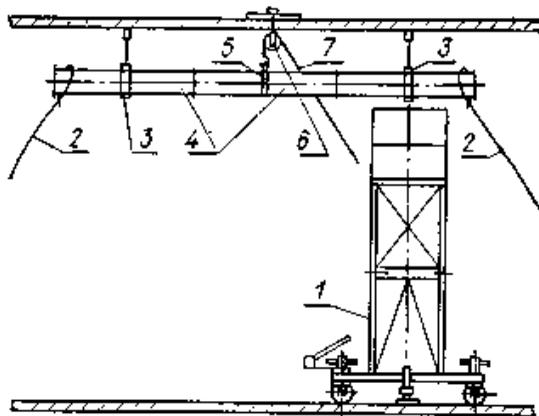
Установка в проектное положение укрупненного блока горизонтального воздухопровода: 1 – монтажная вышка; 2 – оттяжки; 3 – подвески для крепления воздухопроводов; 4 – блоки воздухопроводов; 5 – строп универсальный УСК-2-2; 6 – блок; 7 – канат к лебедке
